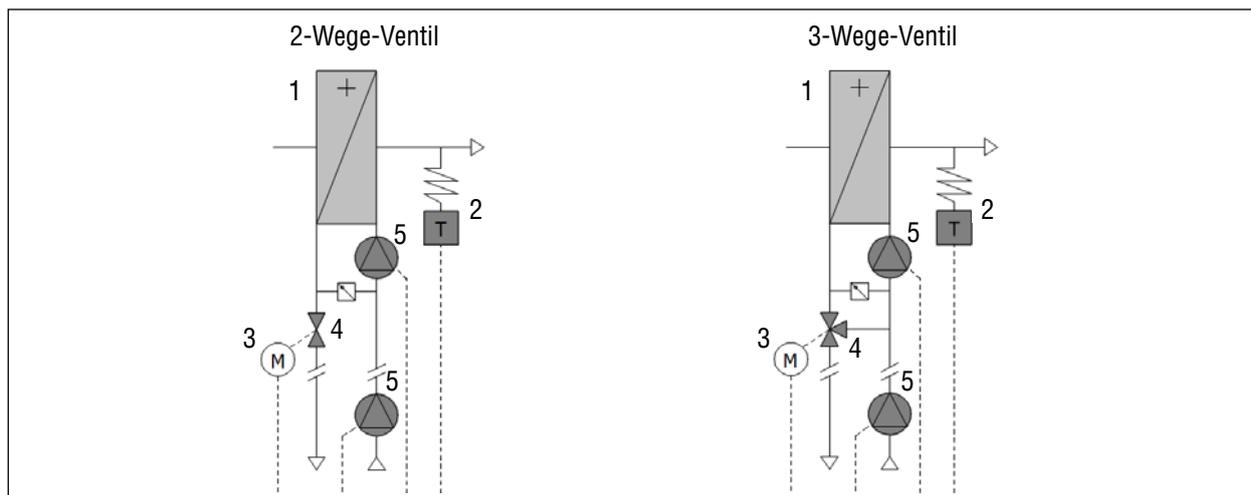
Anschlussausführungen mit 2-Wege-Ventil und 3-Wege-Ventil
